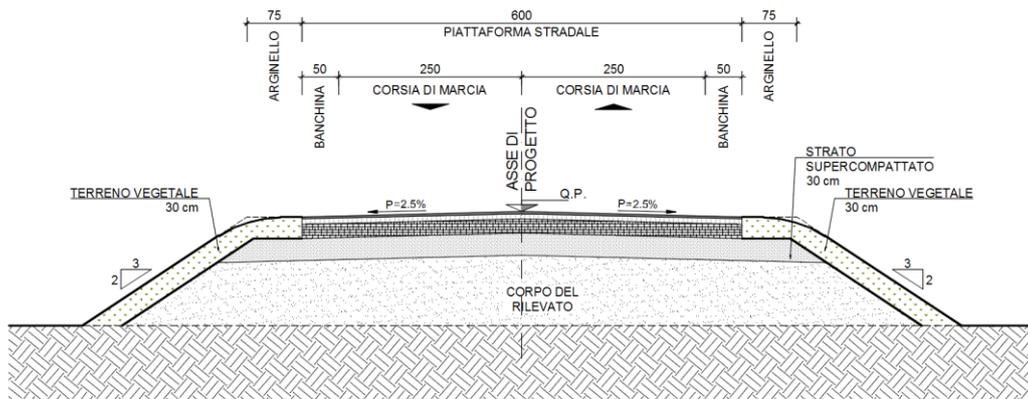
Sezione tipo in rilevato Strada Locale da 6 m
